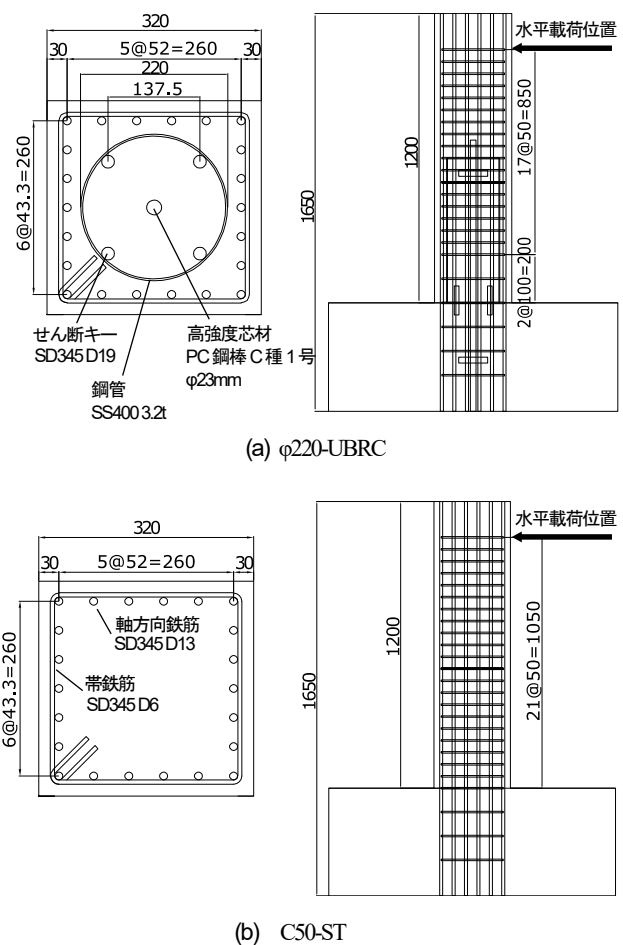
実験供試体の断面図および配筋図 (Unit [mm])
